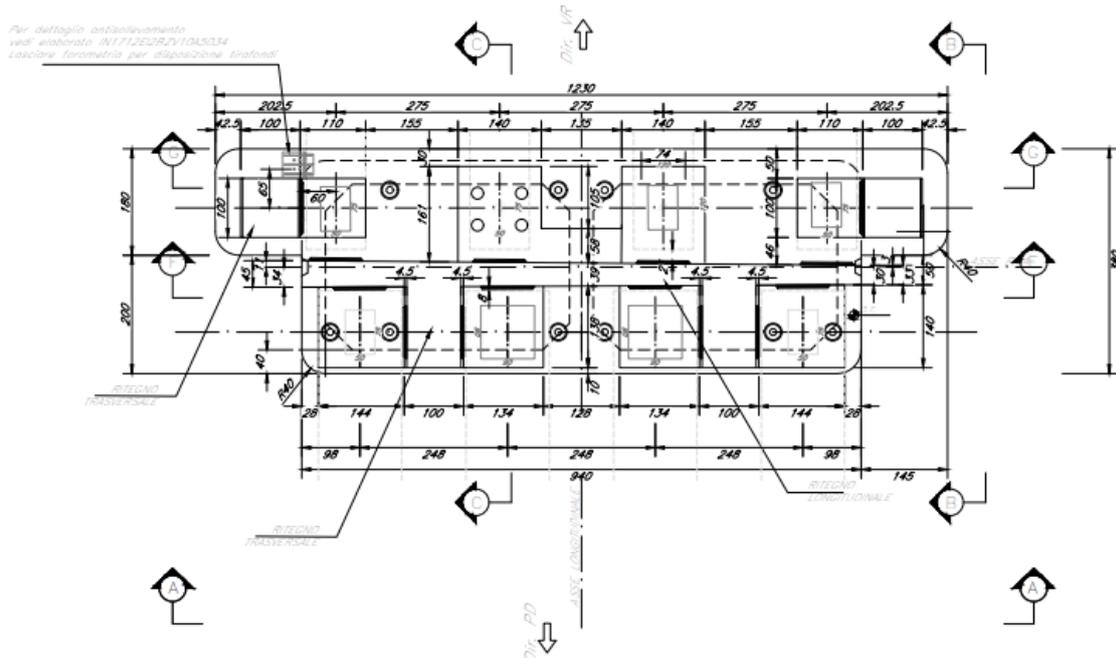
Pianta pulvino e schema appoggi (Allineamento fisso lato impalcato in Misto)
